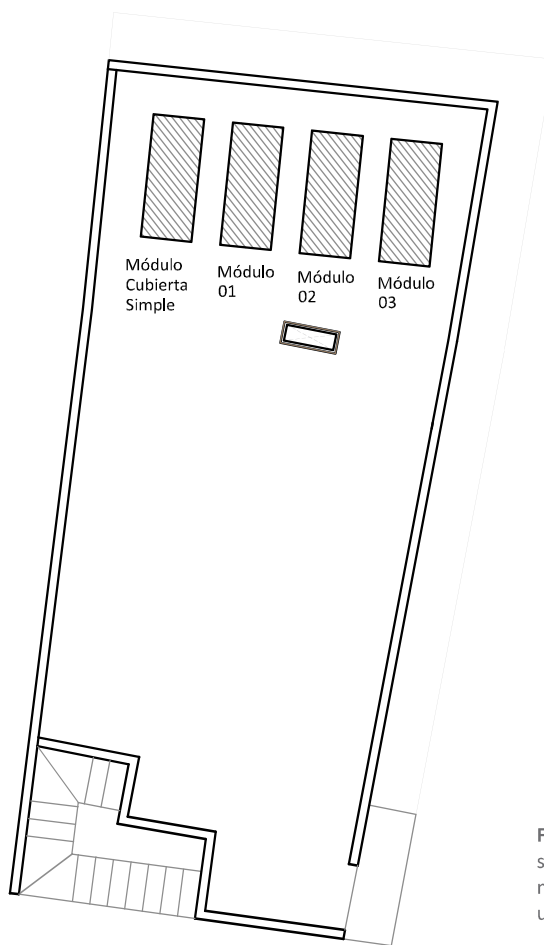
Planta de conjunto del sitio en el cual se instalaron los módulos de Cubiertas Ventiladas utilizadas en el experimento
